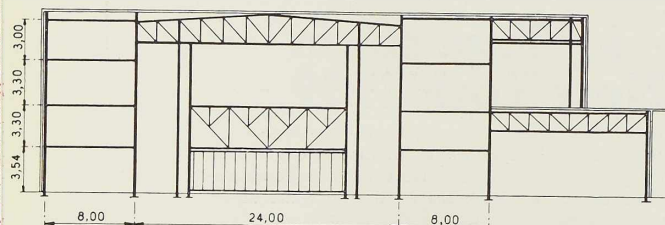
Coupe schématique de l'ossature du pavillon au droit du cinéma.
